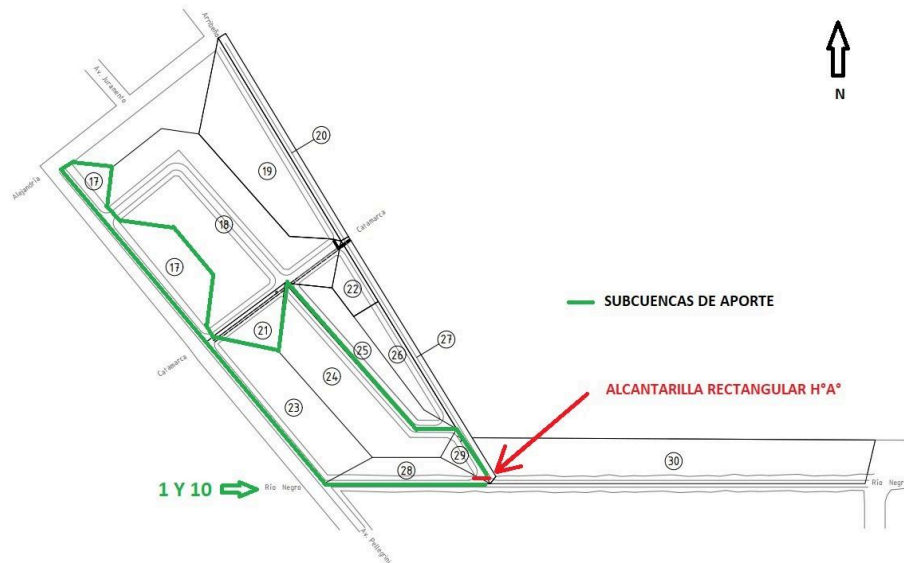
Ubicación de la alcantarilla a diseñar + cuencas de aporte.
